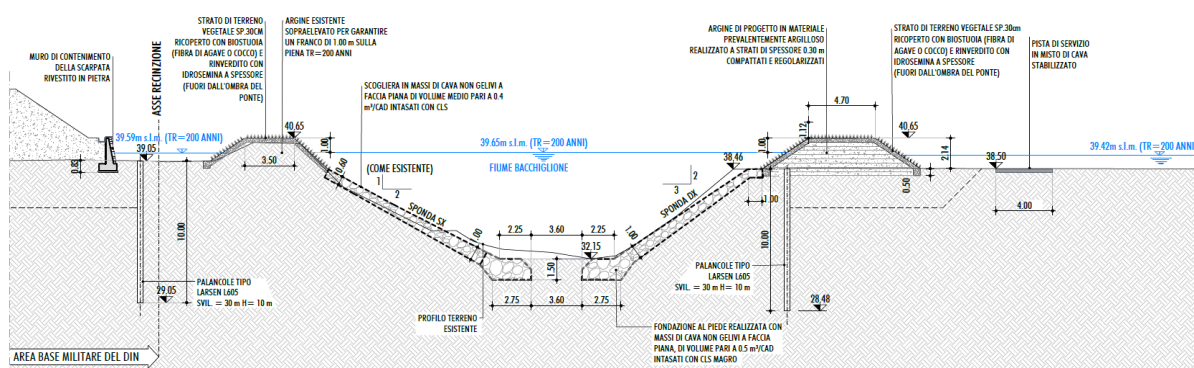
ROGGIA F. BACCHIGLIONE: SEZIONE B-B FUORI DALL'OMBRA DEL PONTE (VISTA DA MONTE)
